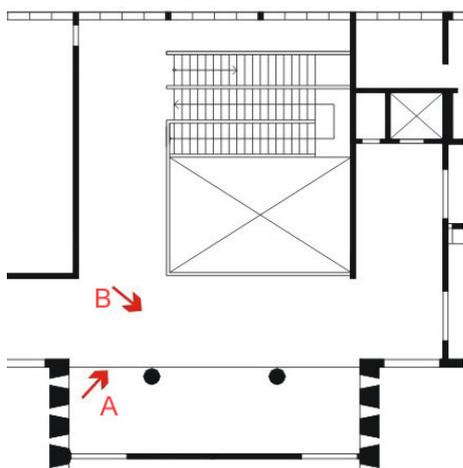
Hall de circulação 1º Pavimento, versão construída. (Desenho da autora).
